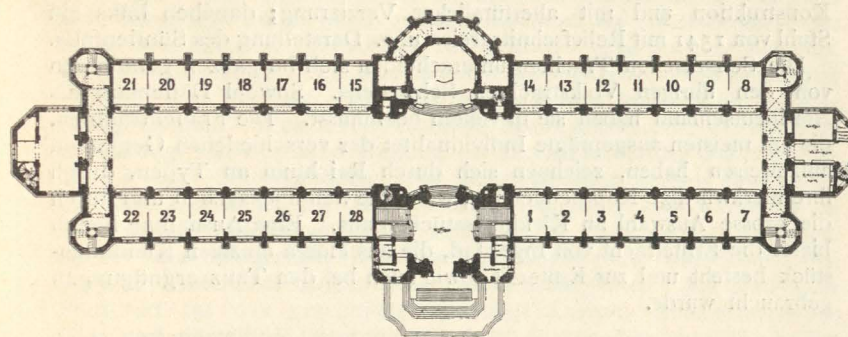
Grundriss des ersten Stockwerkes.
